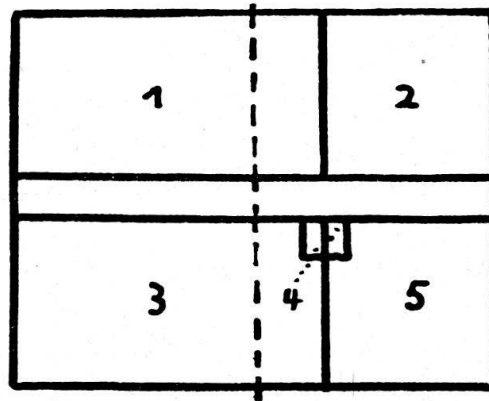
Plan schématique du rez-de-chaussée d'une maison de Morissen
